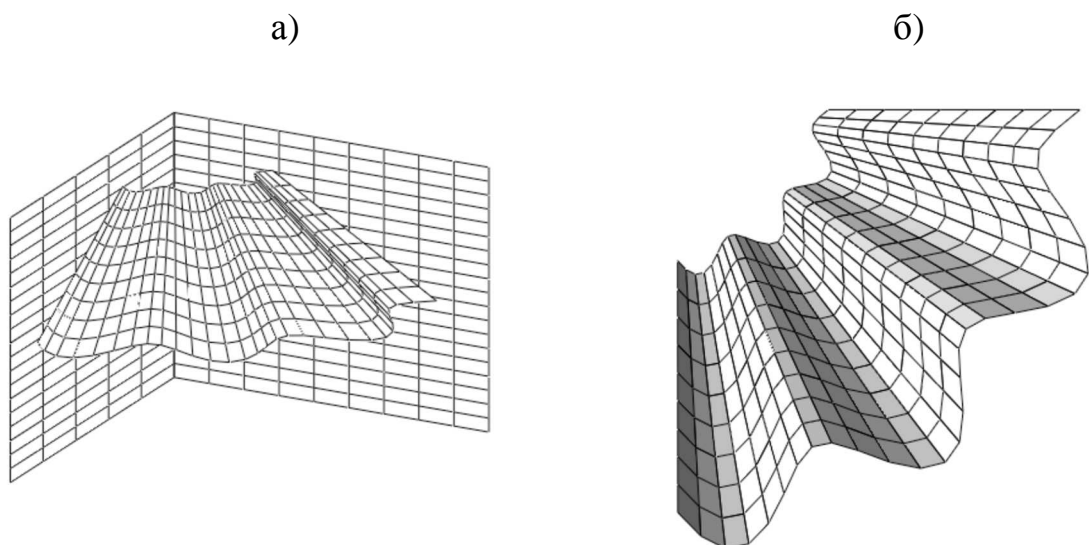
Фігурний дашок: а - загальний вигляд; б - вид зверху
